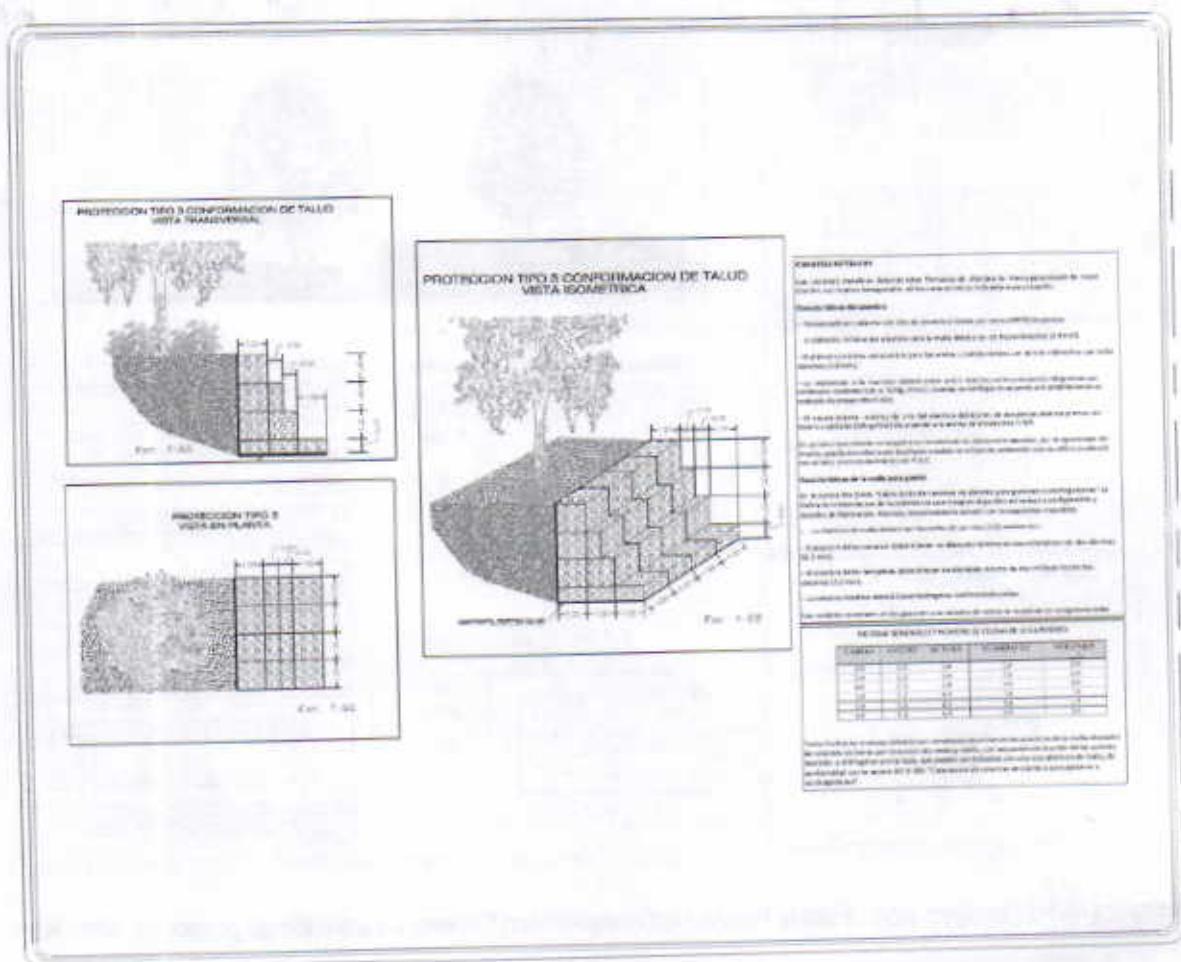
Imagen Tipo, Planos Planta, perfil e isométrico General de solución de protección TIPO No 3
